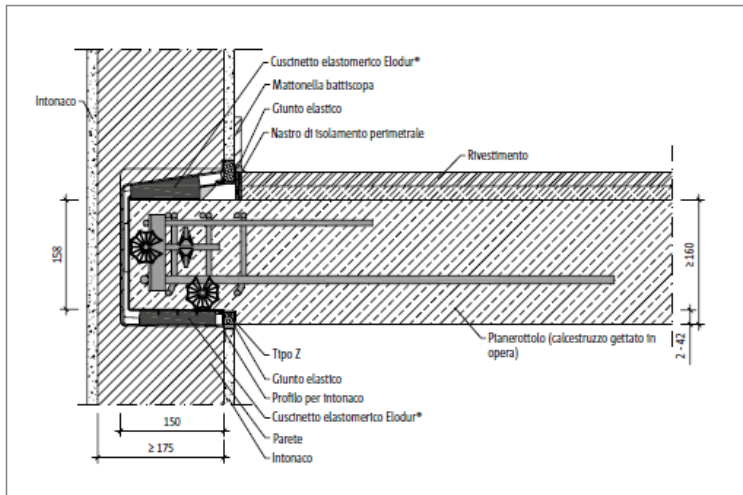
Schöck Tronsole® tipo Z-V+V-T: sezione costruttiva - Pianerottolo in opera
